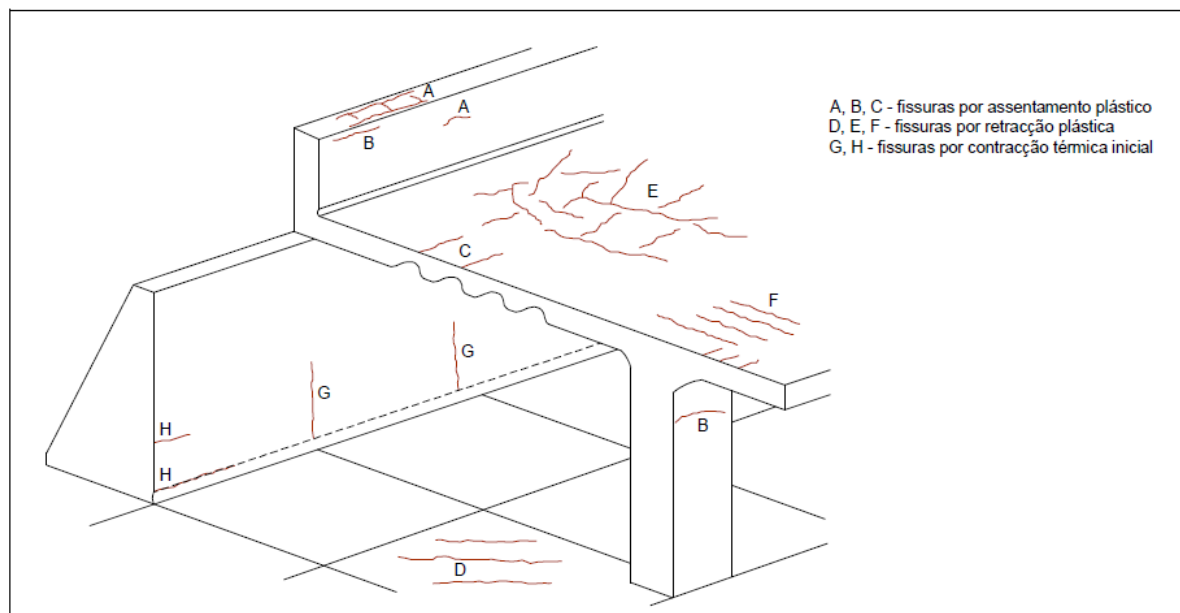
Fissuras precoces no betão (Miranda, 2006).
